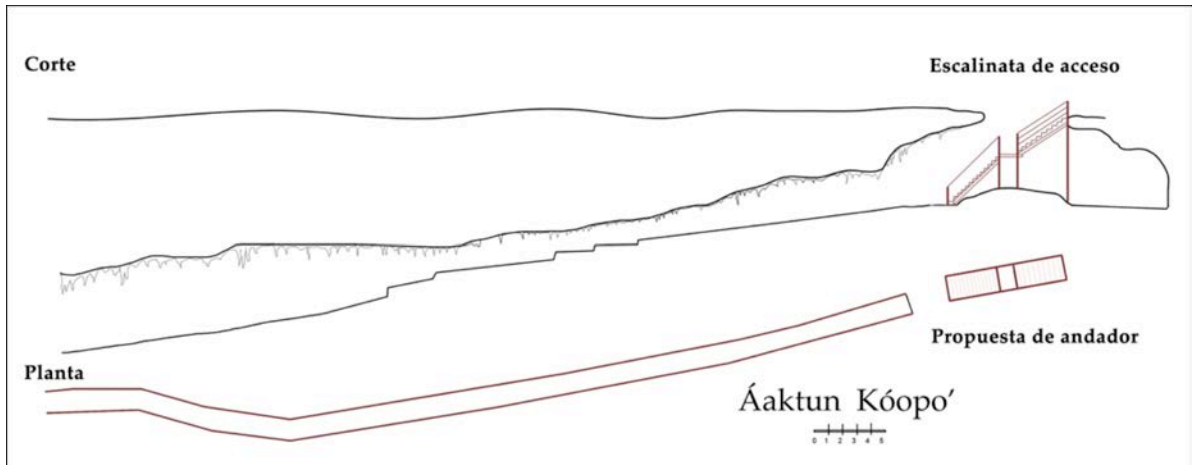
Dibujos de planta y corte del acceso a la caverna, muestra el andador propuesto para su instalación. Dibujo: Fátima Tec
